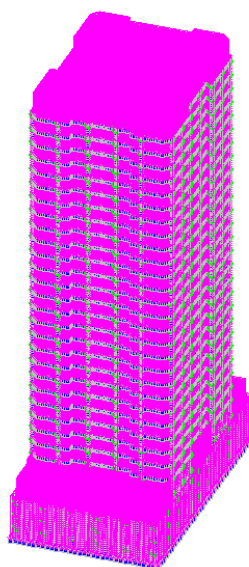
Собственный вес здания с учетом фундаментной плиты
